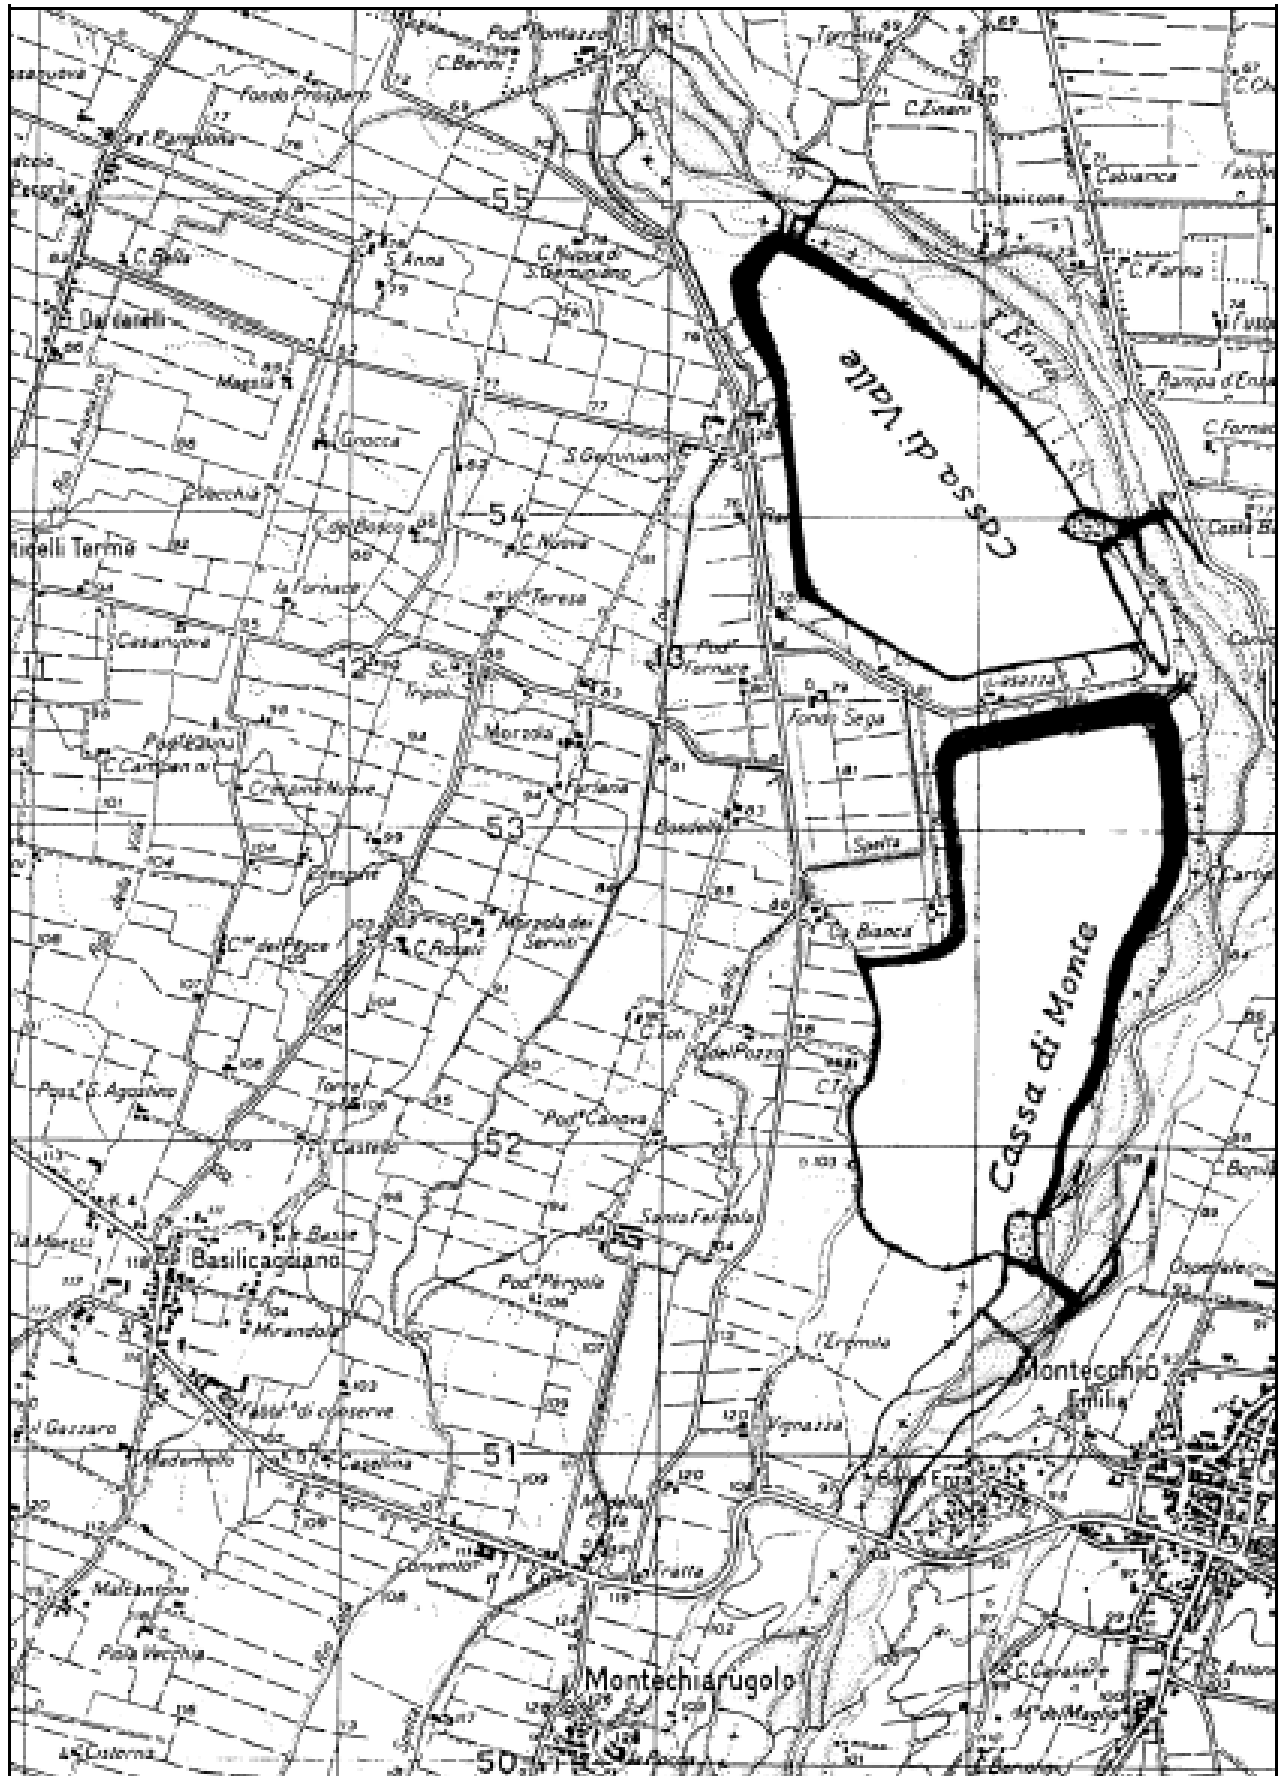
Planimetria storica di Cassa di Monte e di Cassa di Valle.
